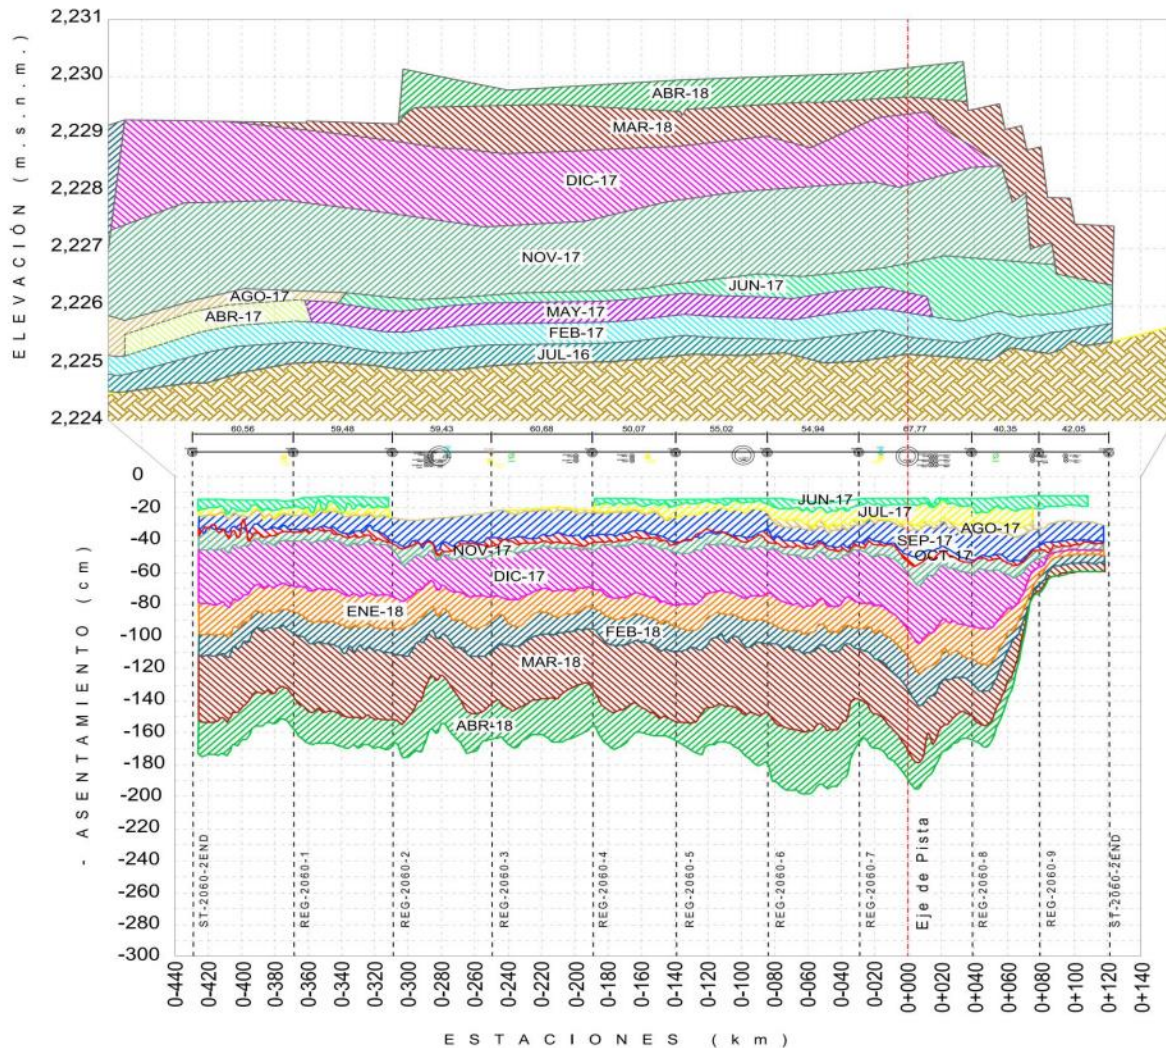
Configuración del tezontle con precarga y perfil de asentamiento cadenamiento 2+060 (CFE, 2018)
